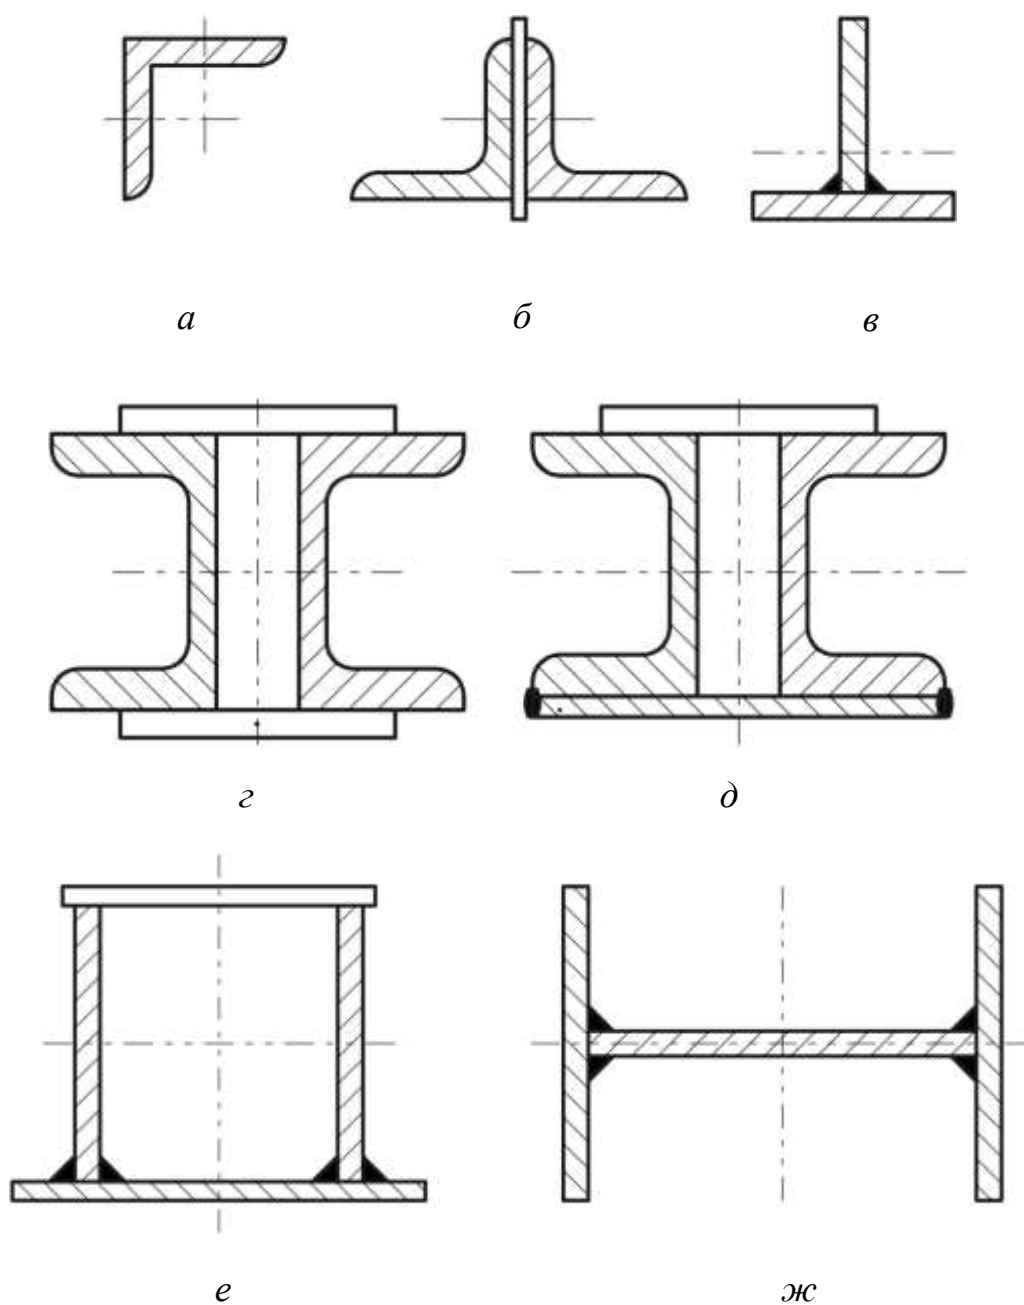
Виды поперечных сечений растянутых поясов фермы
